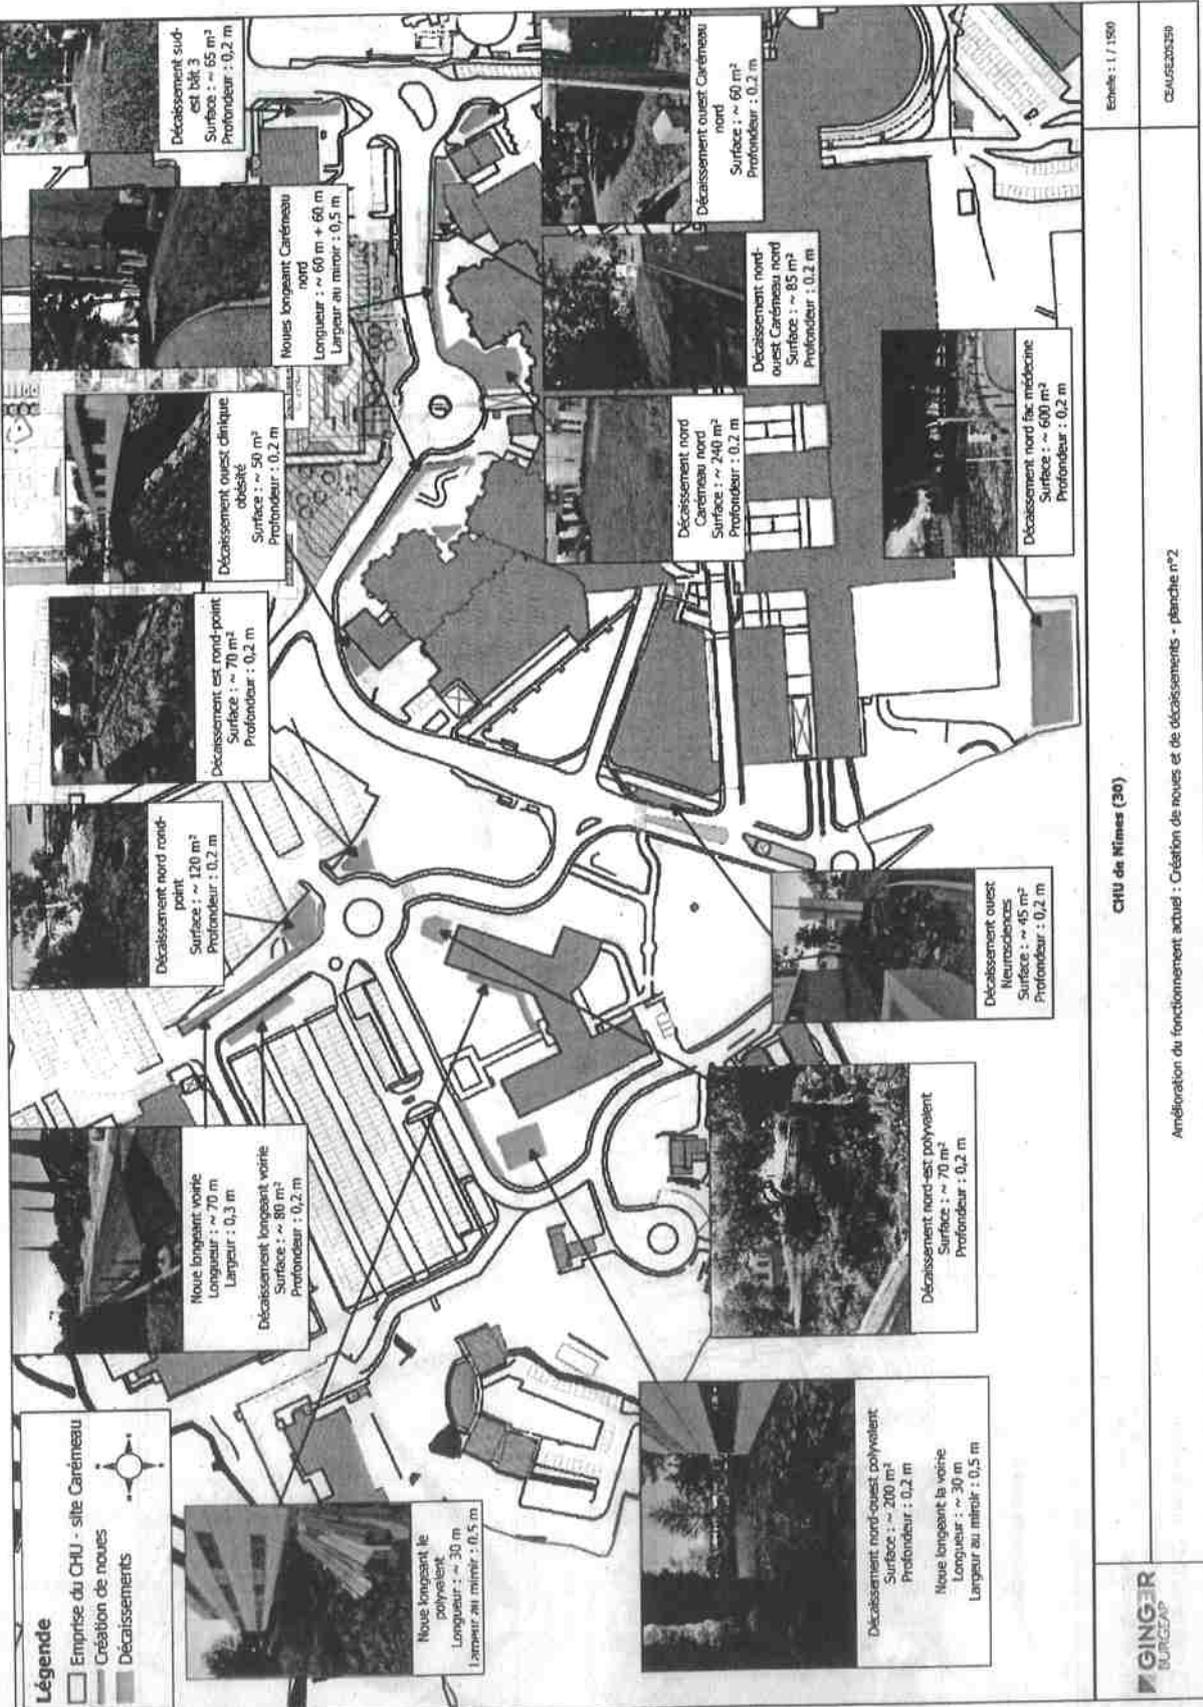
Amélioration du fonctionnement actuel, création de noues et de décaissements, planche n°2 (source : GINGER BURGEAP sur plan de masse du CHU)
